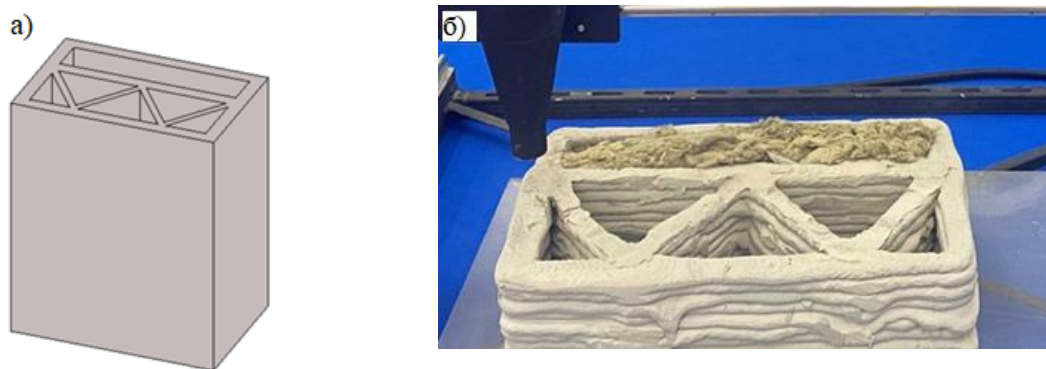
Конструкции стен для строительной печати: а – макет стены, б – напечатанная стена
